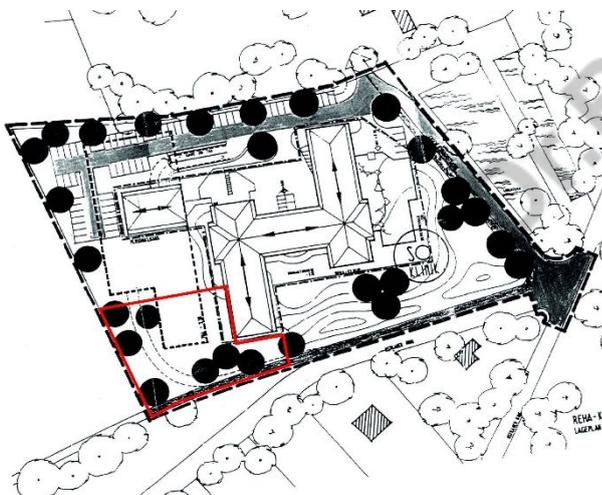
Rechtskräftiger Bebauungsplan i.d.F.v. 28.10.1992 mit Änderungsbereich
